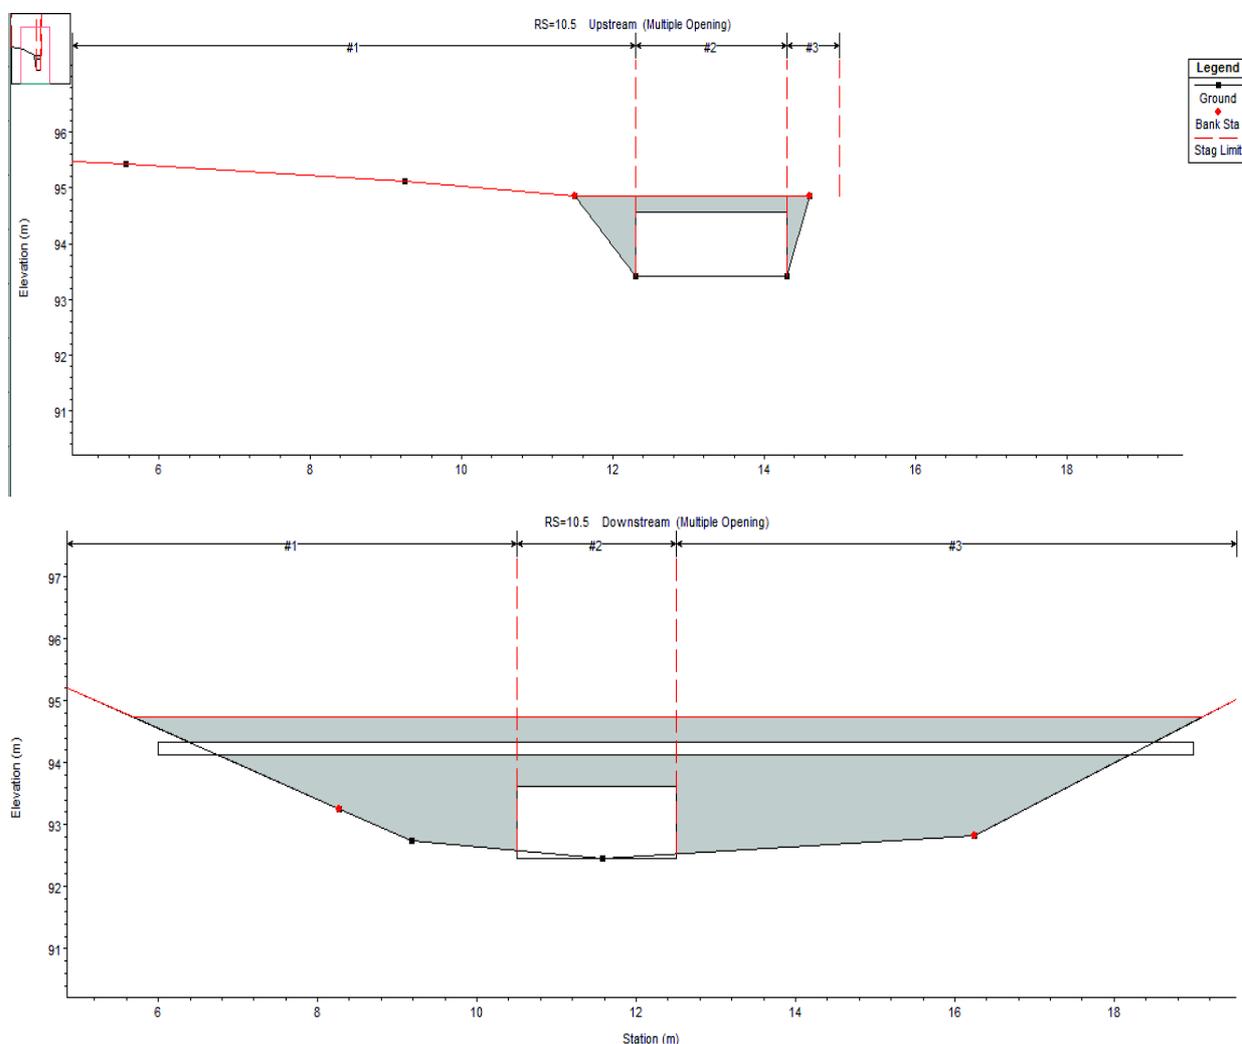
Section amont et aval de l'ouvrage à mettre en place
